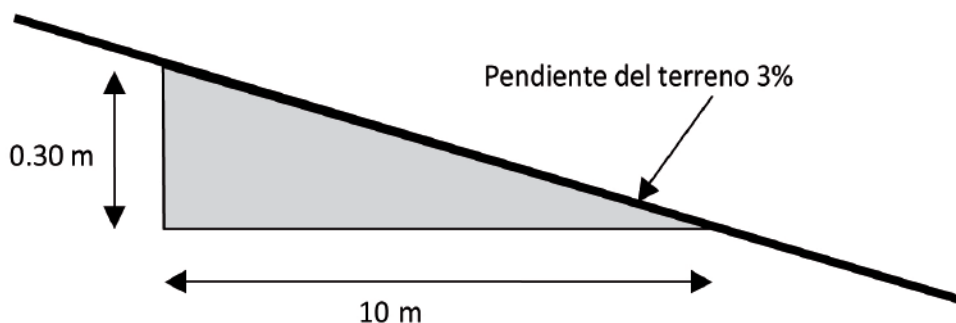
Perfil transversal de la excavación para el vertedero de máximas
